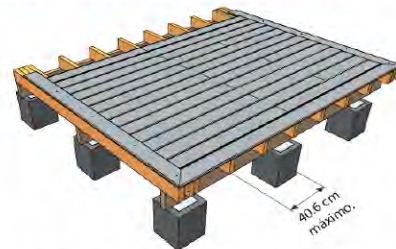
Plydeck. Fuente: Plycem Elementia materiales. Manual de instalación, 2021. www.plycem.com
